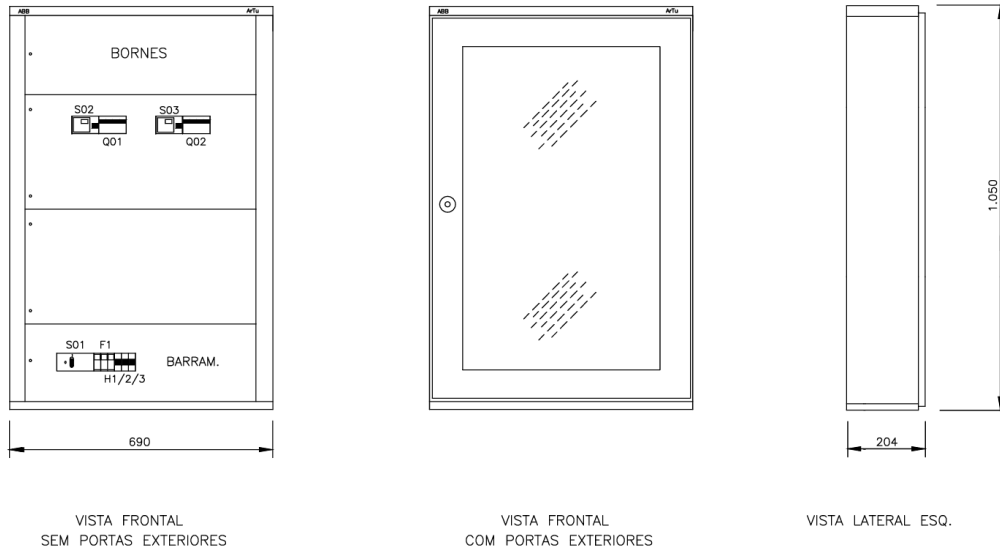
Layout* do quadro dos esterilizadores horizontais.
